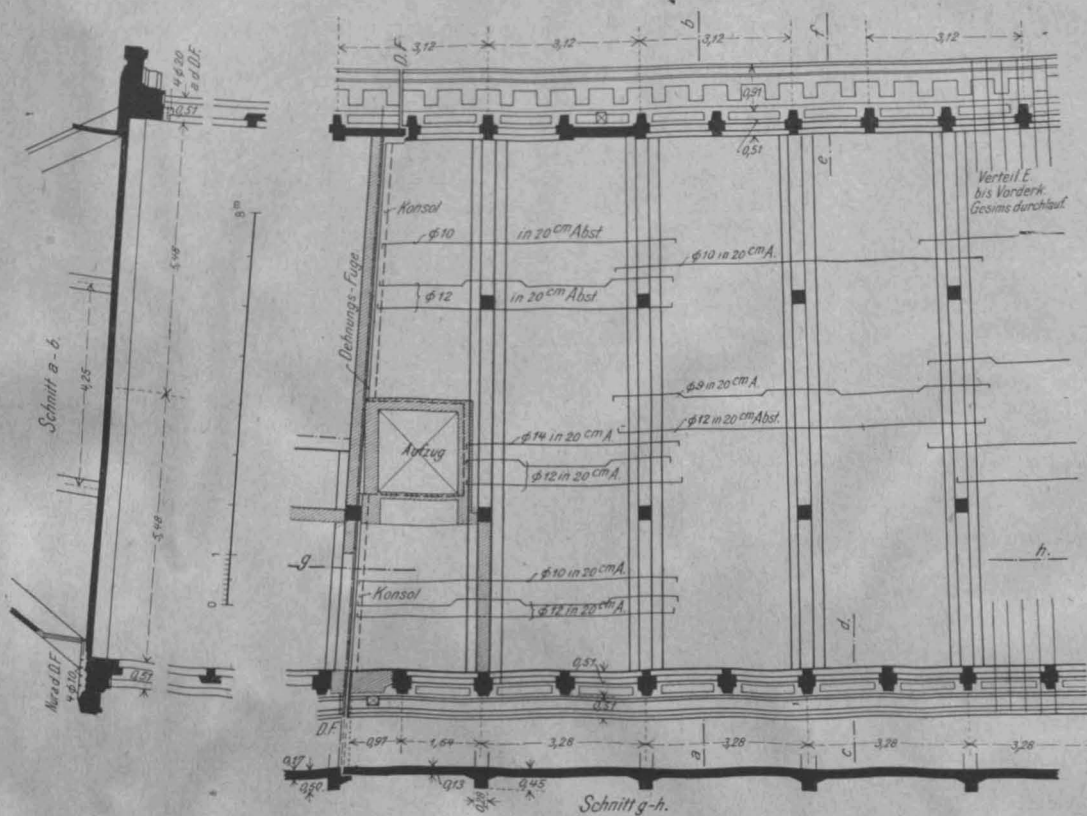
Anschluß des Flügels an den Mittelbau mit Ausdehnungsfuge in Wand und Decke. IV. Obergeschoß.
